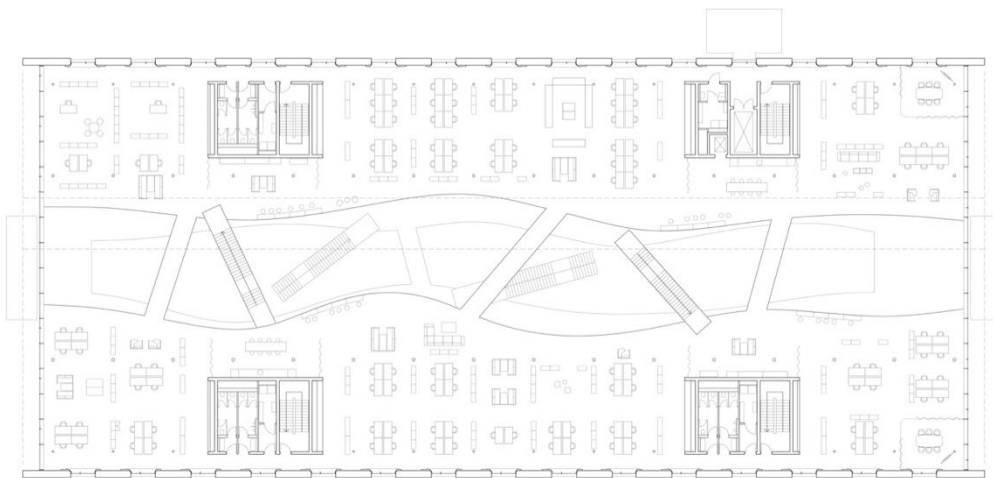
Grundriss 2. Obergeschoss Arbeitswelt haascookzemmrich STUDIO2050
